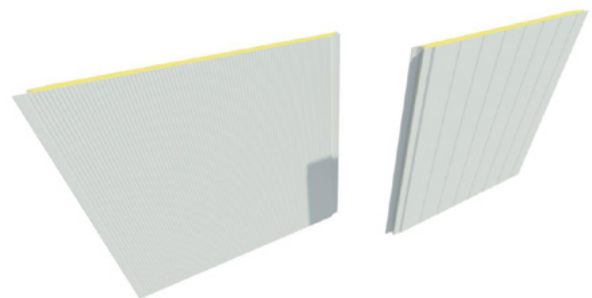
Tipologia de objeto disponível para painel termoisolante termilor wall – face externa e face interna.
